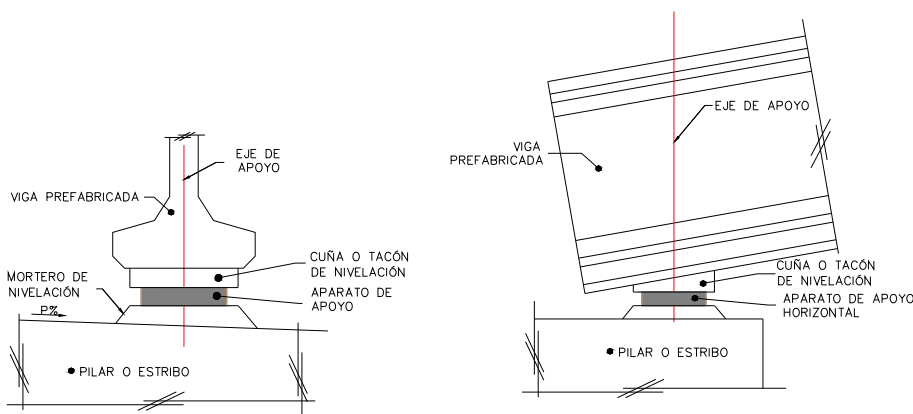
Detalle tipo de colocación de aparatos de apoyo en puente de vigas prefabricadas.
